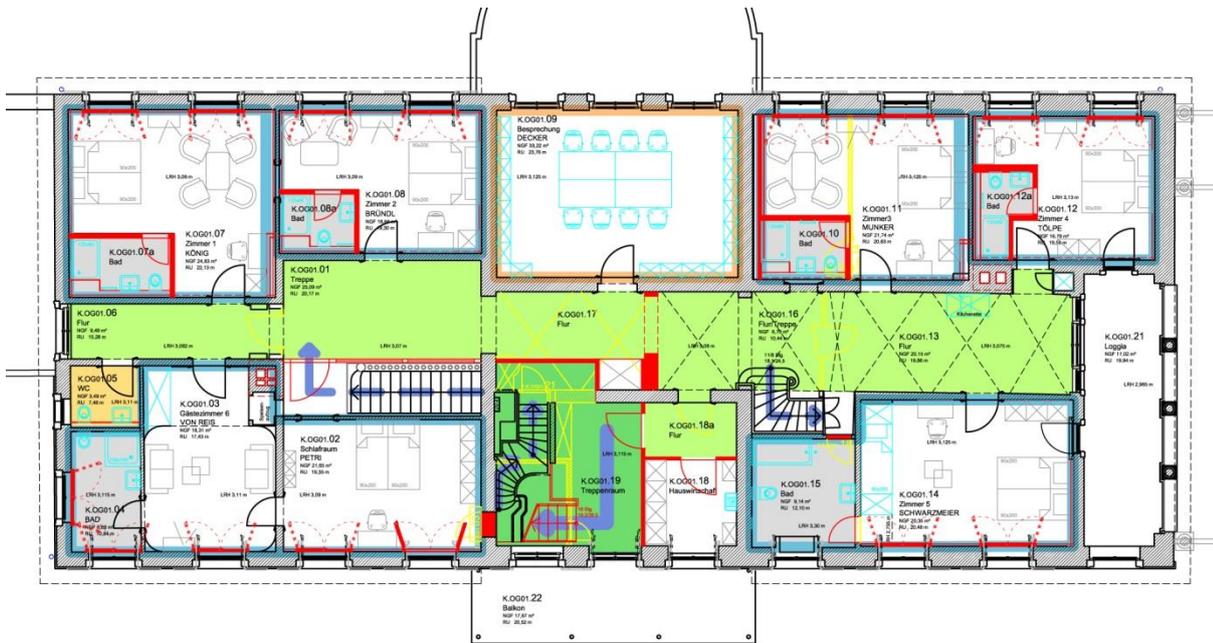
Grundriss 1. Obergeschoss mit modernisierten Badzellen, Architekten Keß und König
